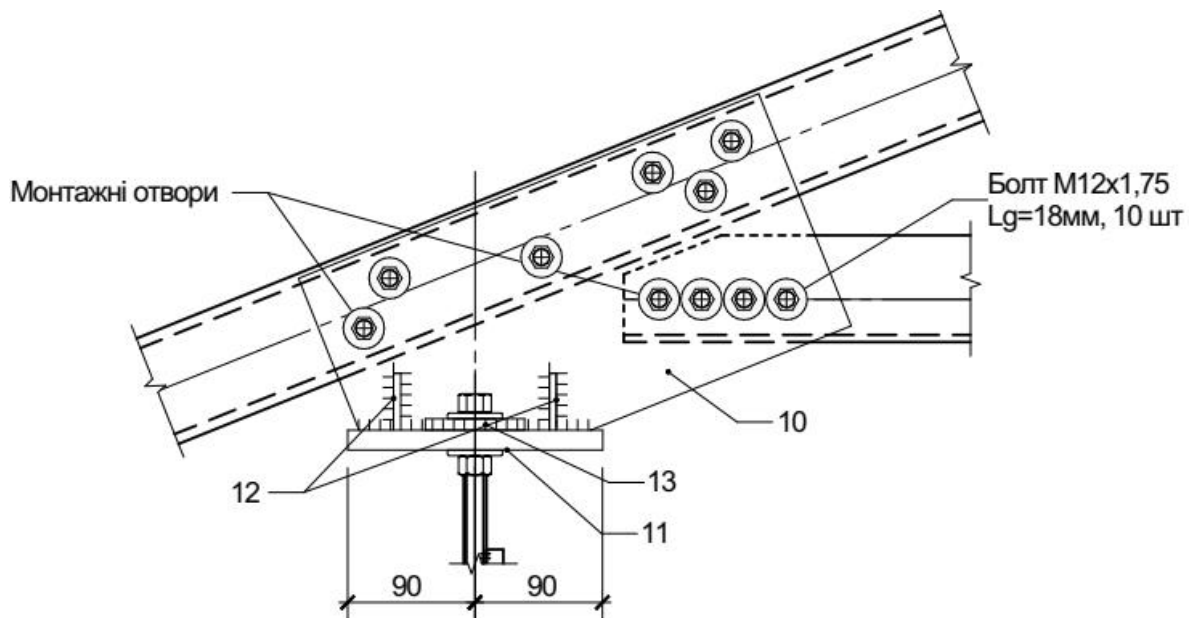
До розрахунку проміжного вузла нижнього поясу
